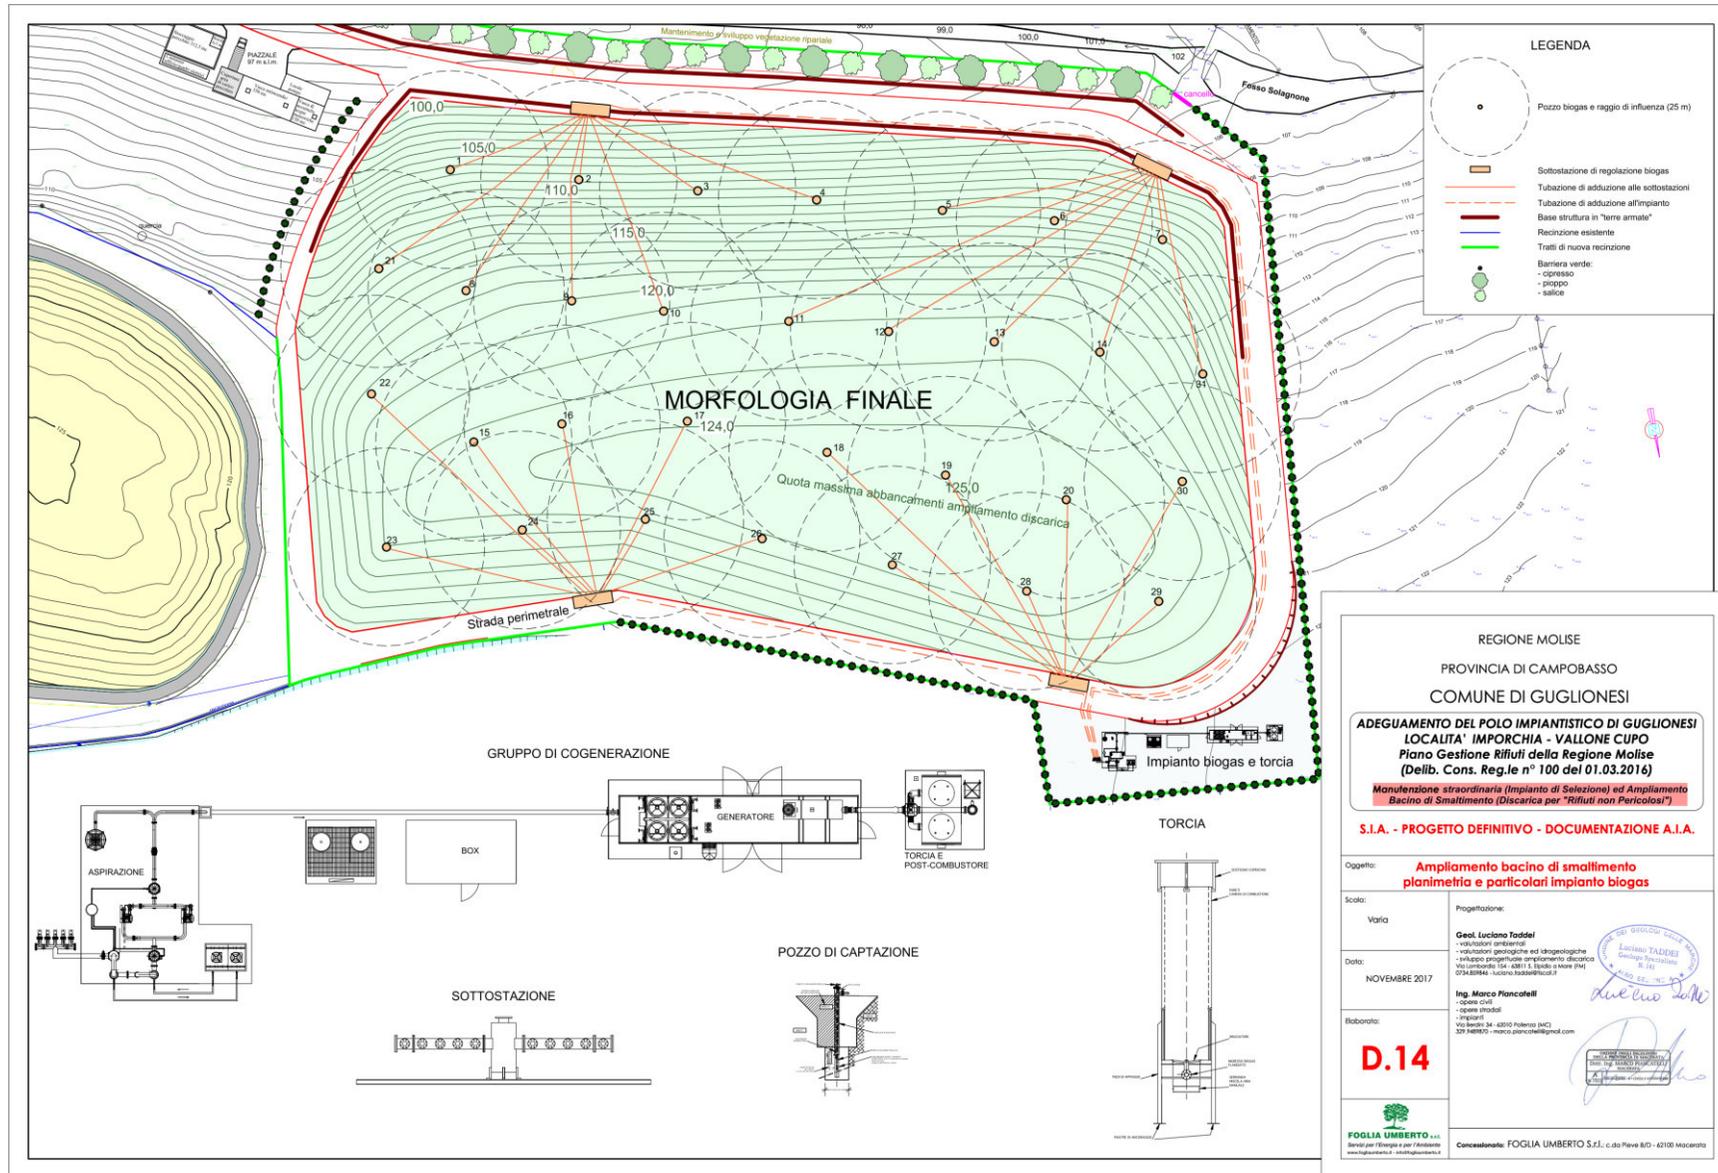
planimetria generale dell’impianto di captazione e gestione del gas di discaricai: assetto “post operam”
